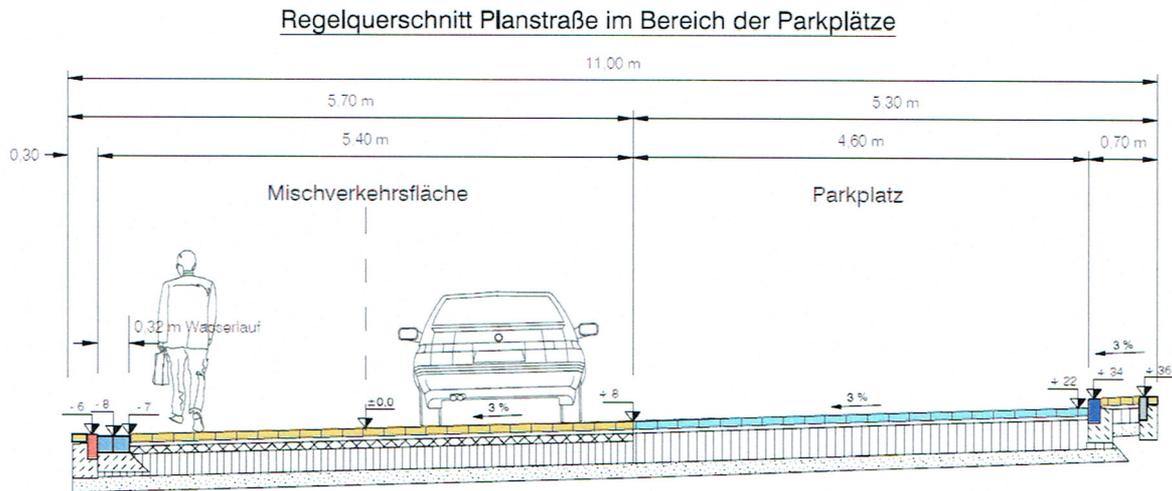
Regelquerschnitt der Planstraße im Bereich der Parkplätze (Wack+Dähn Ingenieurbüro GmbH, 2017)
